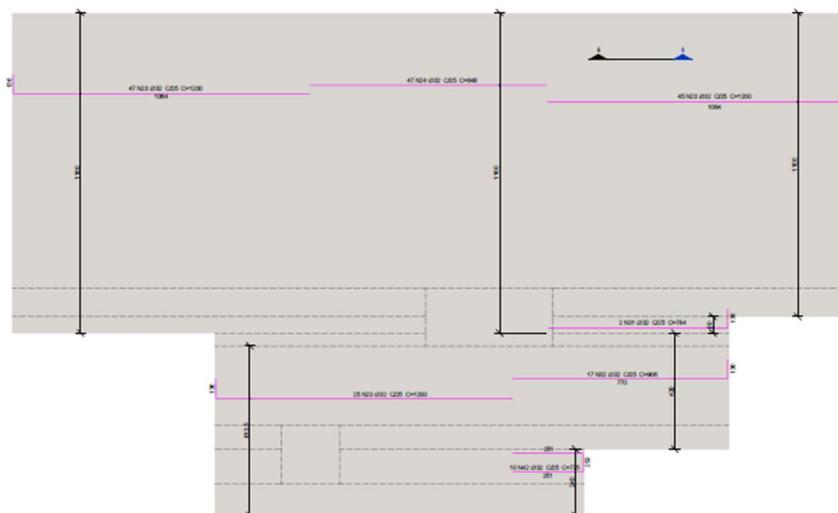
Layout do bloco de fundação do empreendimento Eco Parahyba.
